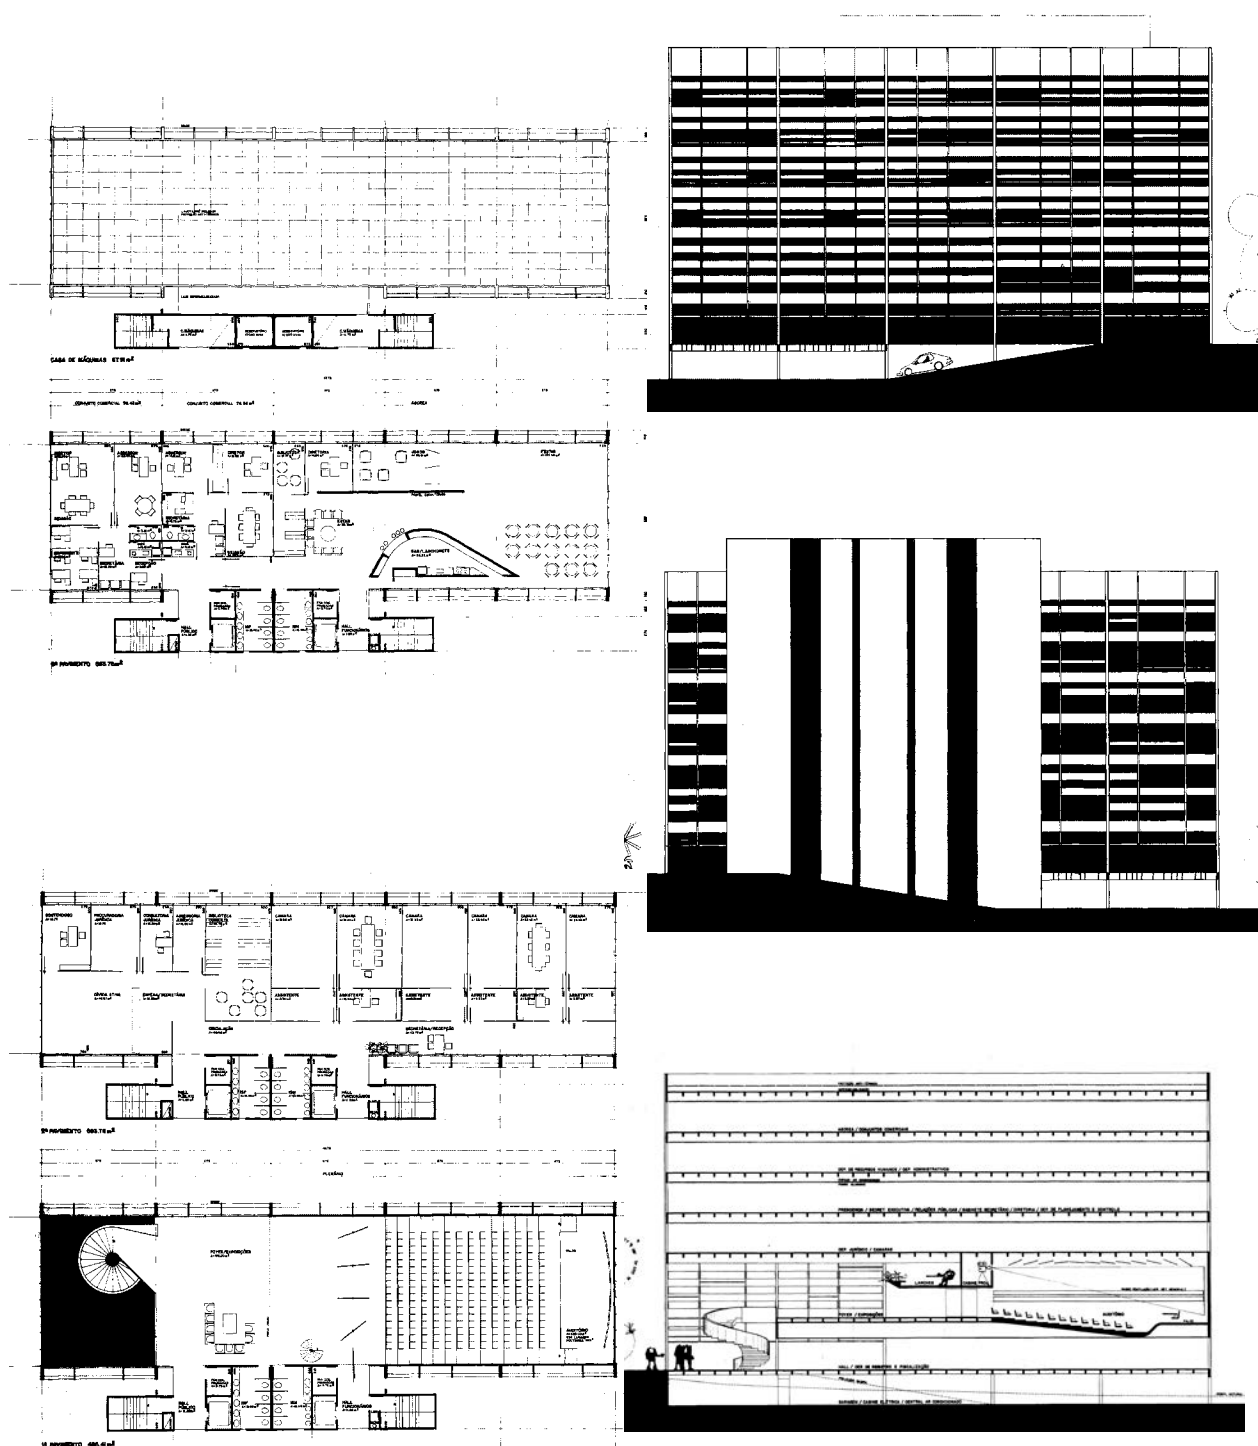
1º prêmio concurso sede CREA PR; planta tipo modular;
